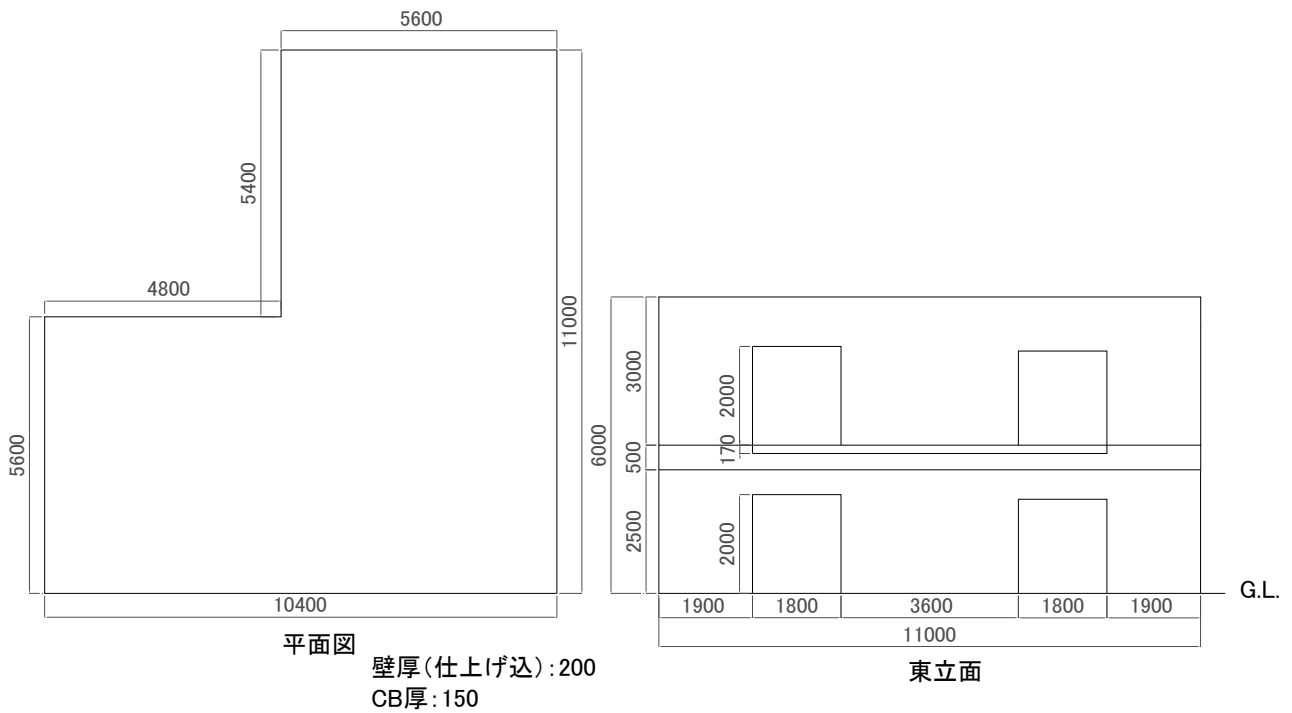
CB造2層建物の平面図・立面図 (単位: mm)
